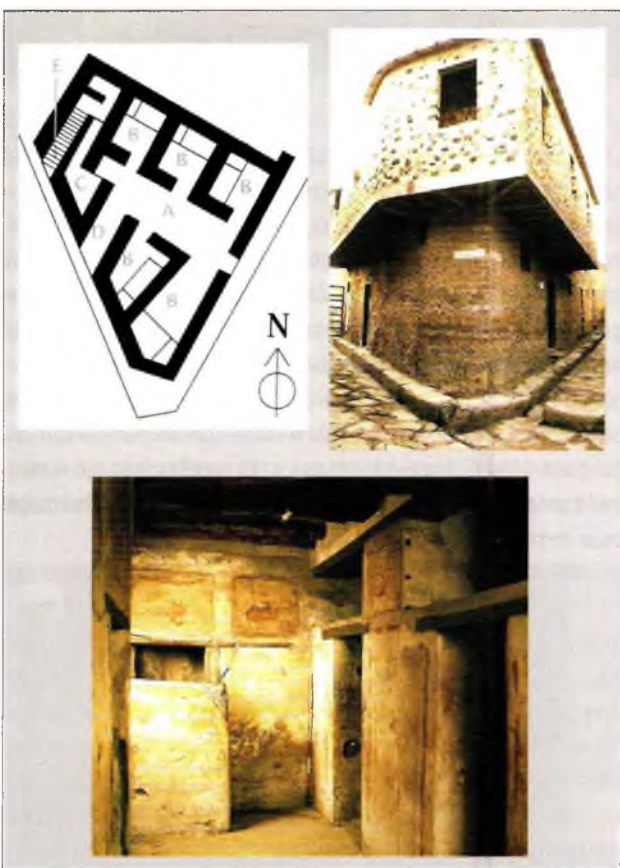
Planta del Lupanar de Pompeya (de S. Napo). A: vestibulo. B: cubiculos. C: letrina. D: entrada secundaria. Vista de la fachada y vestibulo con puertas de acceso a los cubiculos.
